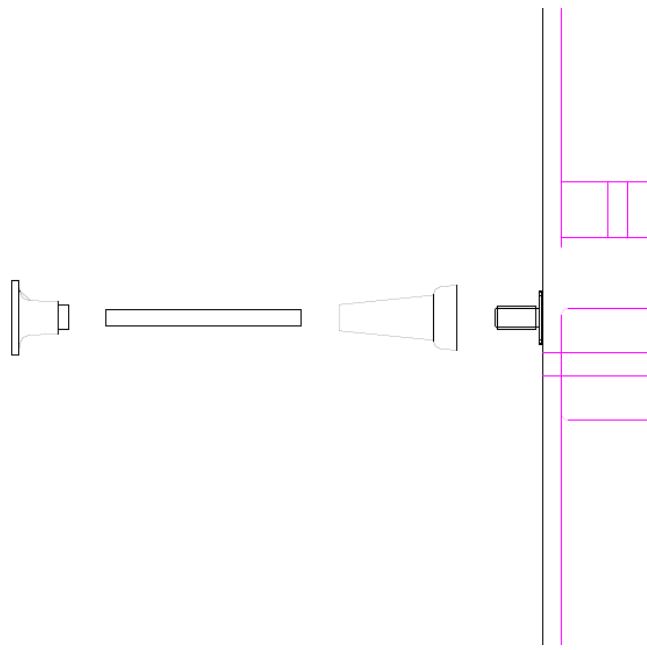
De izq. a der. se colocan: el pie de anclaje, la barra roscada, el cono y el posicionador cono.
